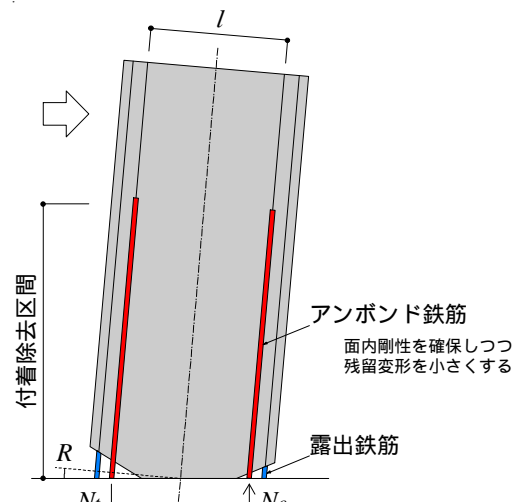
ひび割れ制御型RC造耐震壁の概略図
